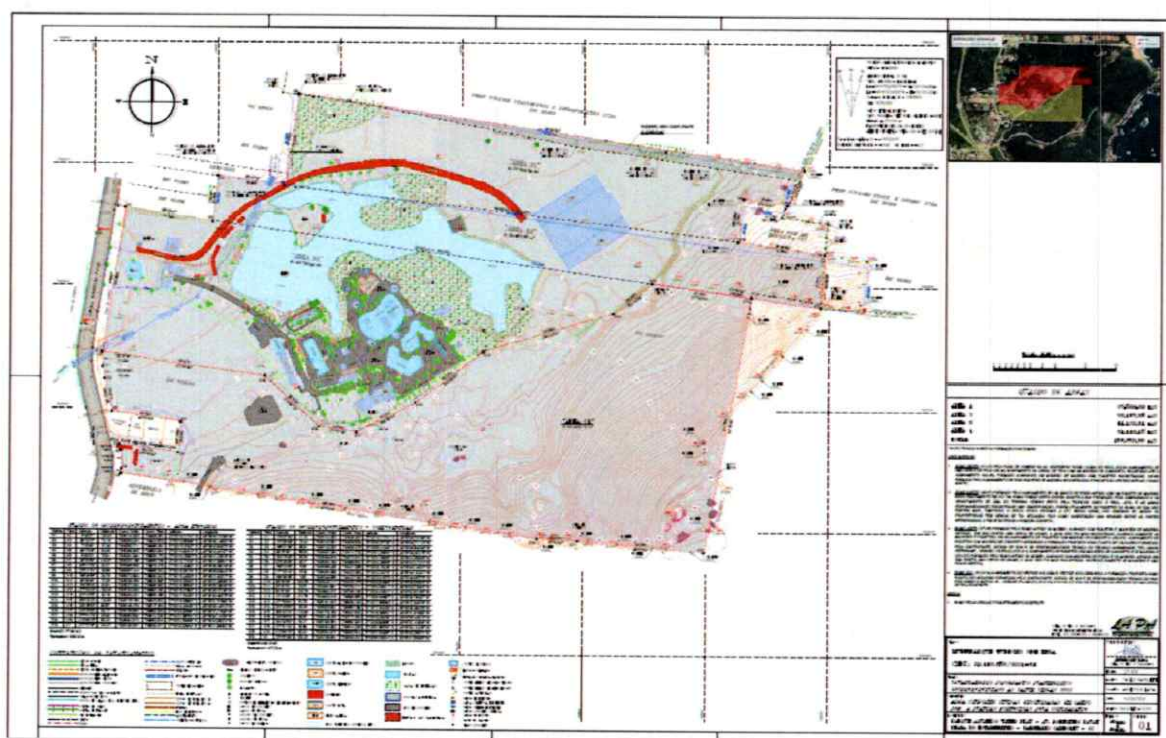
Levantamento Topográfico Planimétrico. Fonte: Eng.º Anderson Lapa
